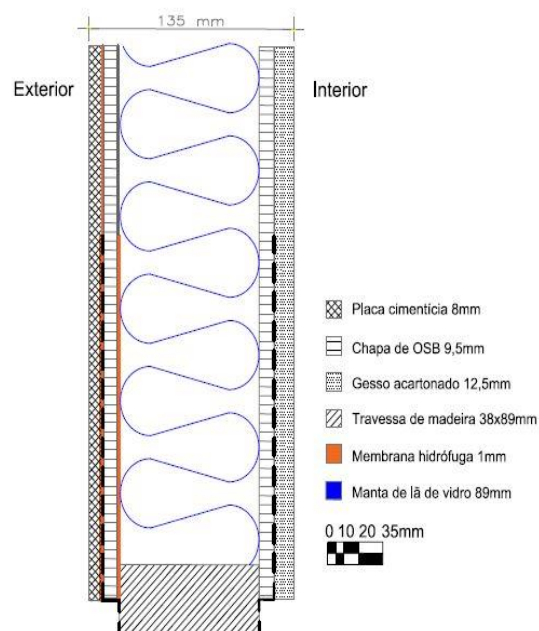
Corte seção transversal do painel de Wood Frame com núcleo em lã de vidro e câmara de ar não ventilada.
